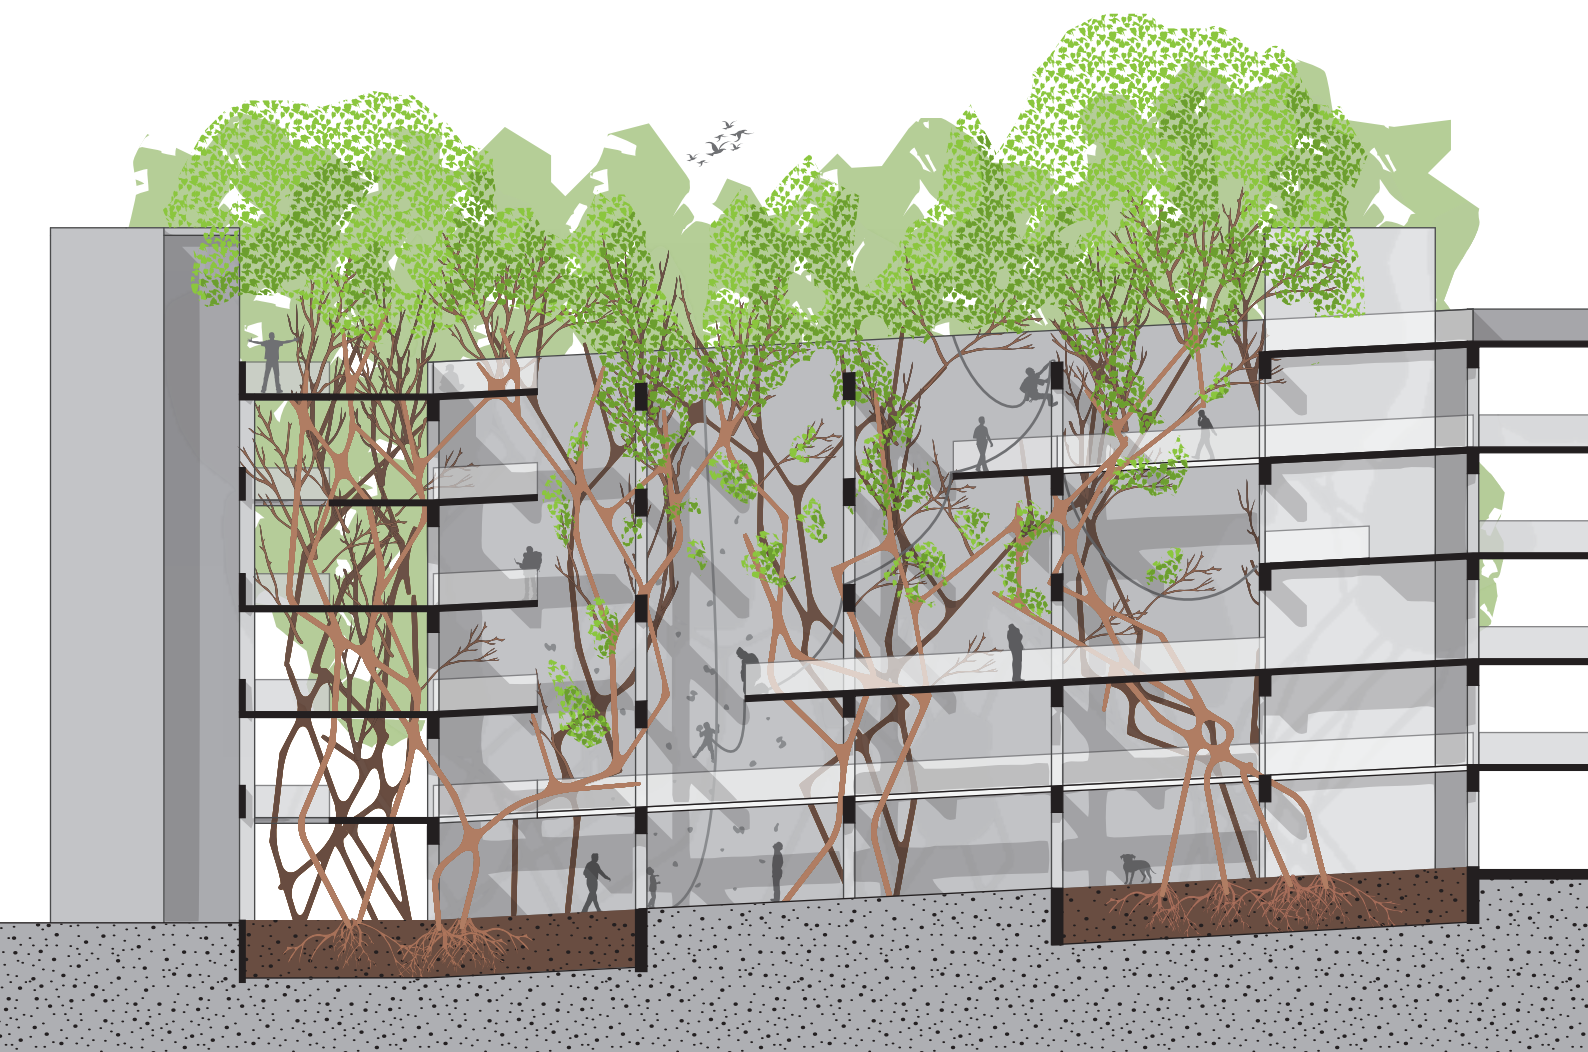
Längsschnitt im nördlichen Bereich M 1:200
